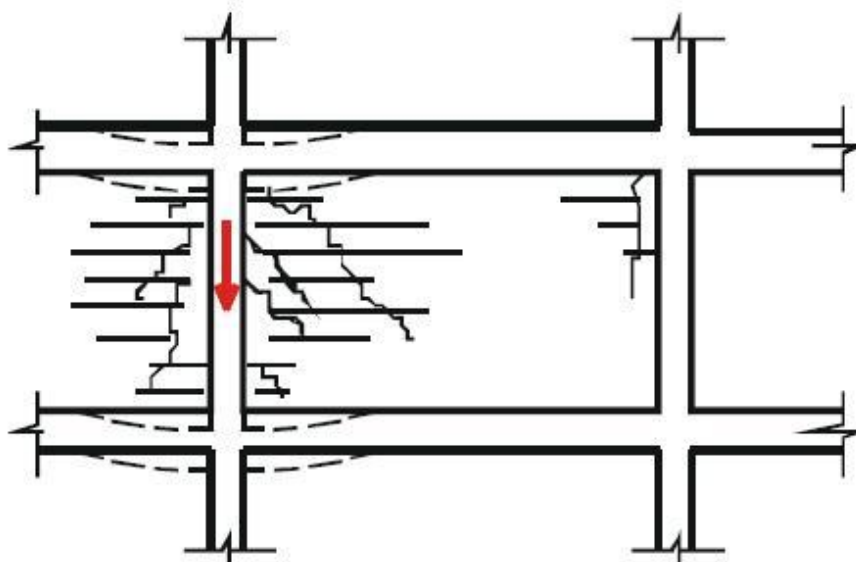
fissuras ocasionadas por recalques diferenciais entre pilares (THOMAZ, 1989, p. 98)
